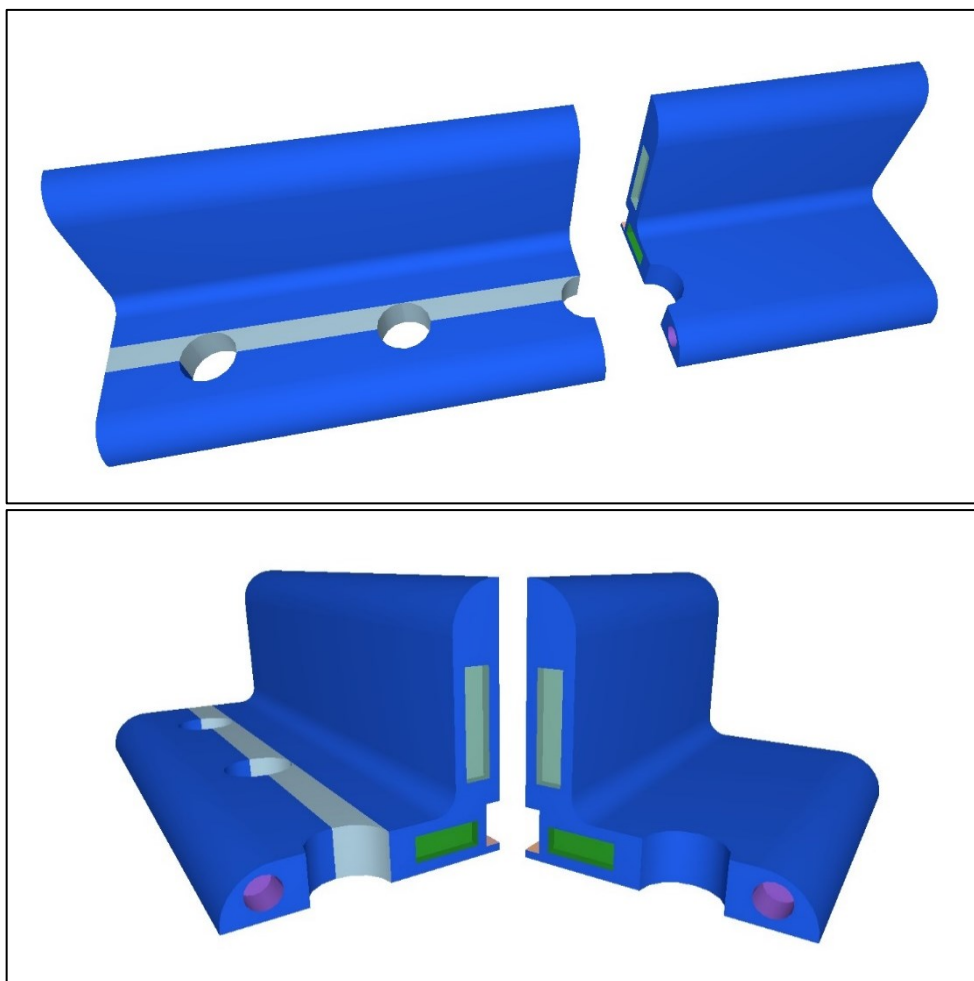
Esquema de união das cantoneiras à chapa de ligação.
